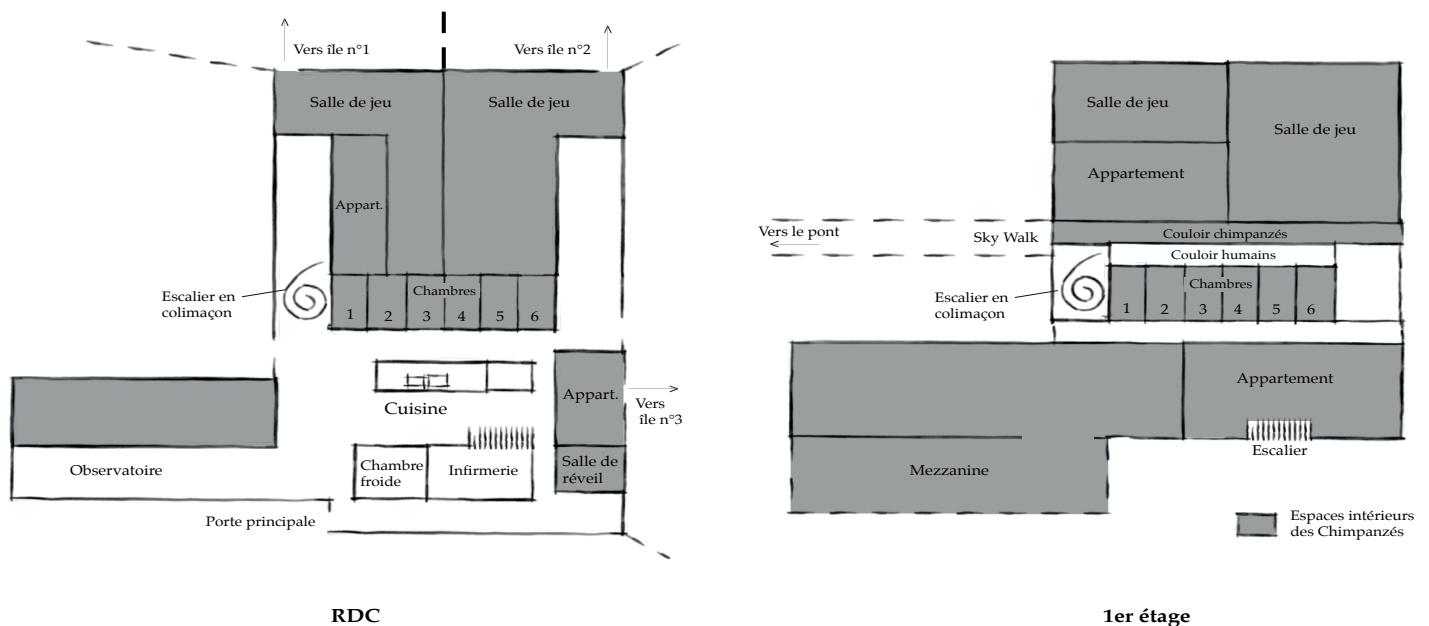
Plan de la *Chimp House*, Fondation Fauna, QC, Canada
